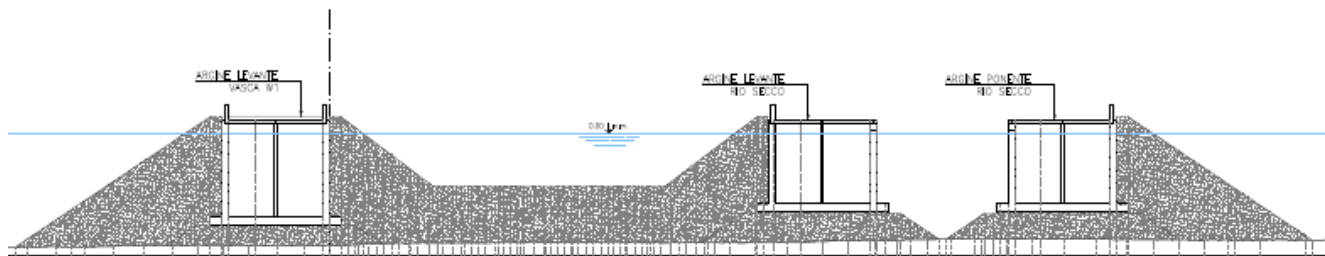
Sezione trasversale di progetto della Vasca W1 Bacino Nord e Rio Secco
